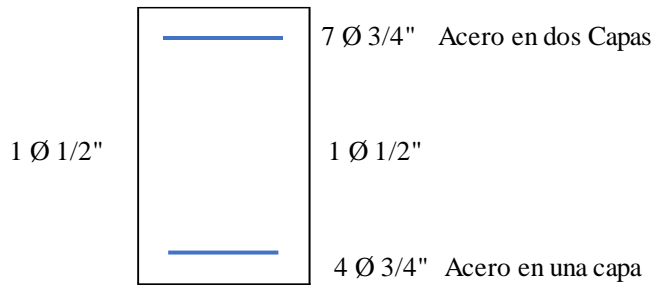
Distribución del Acero longitudinal de VC-100 (40x90) - Sistema estructural tradicional.
